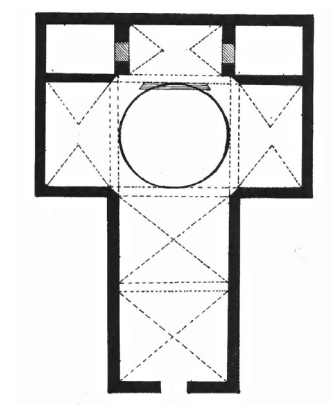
Lazcano. Convento de Santa Ana. Iglesia. Planta
